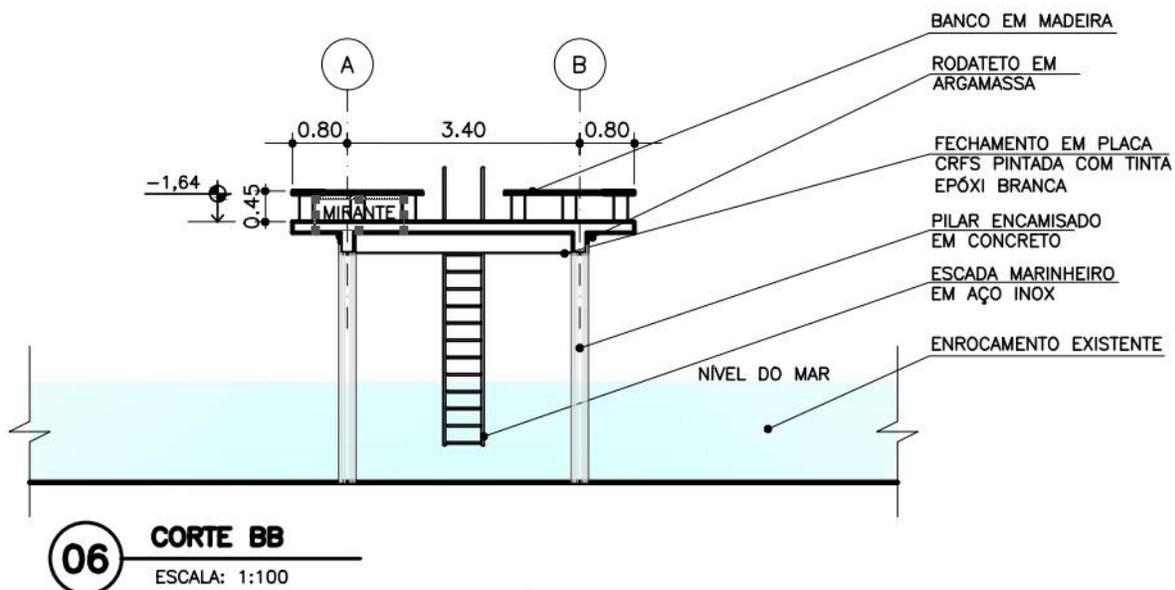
Detalhe de Forro em Placas Cimentícias para proteção do fundo de laje
